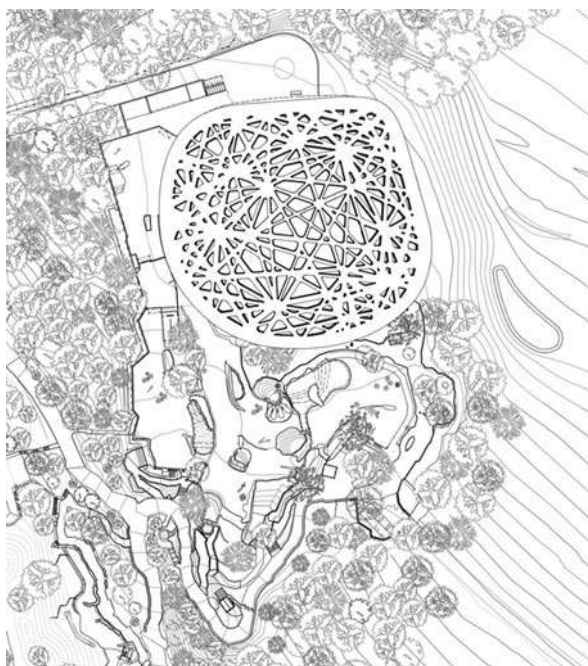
Markus Schietsch Architekten, Elephant House, Zurigo (CH), pianta della copertura (markusschietsch.com/elefantenhaus-zoo-zuerich/, 20/08/2020).
